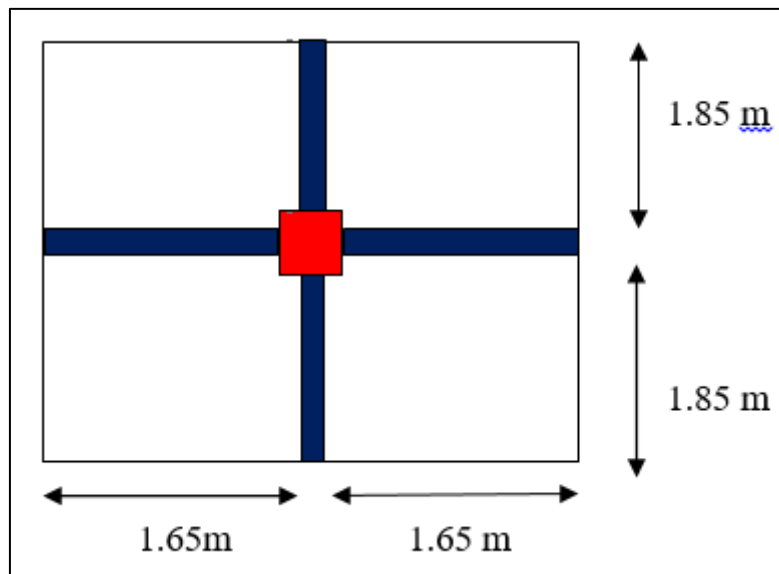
Surface du plancher revenant au poteau le plus sollicité
